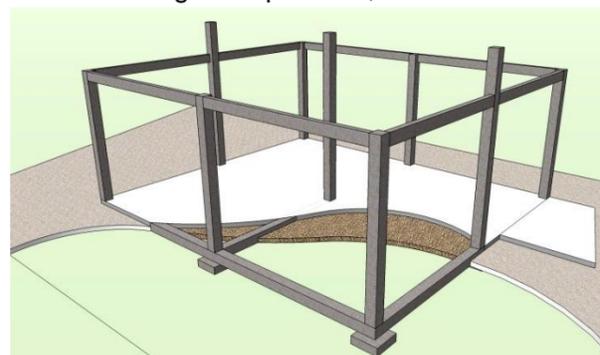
Modelo digital de la estructura de hormigón armado y piso de hormigón simple.
